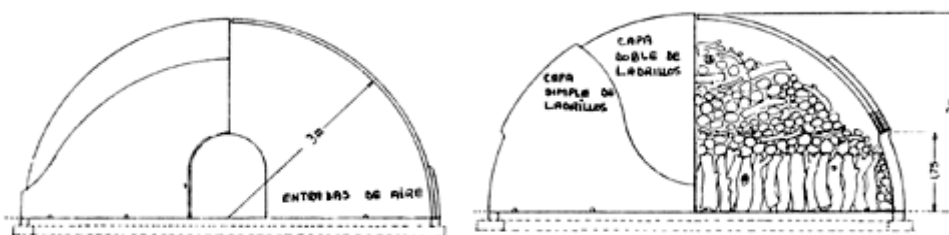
El horno es semiesférico, con dos puertas opuestas para facilitar la carga y descarga y para ventilar.
